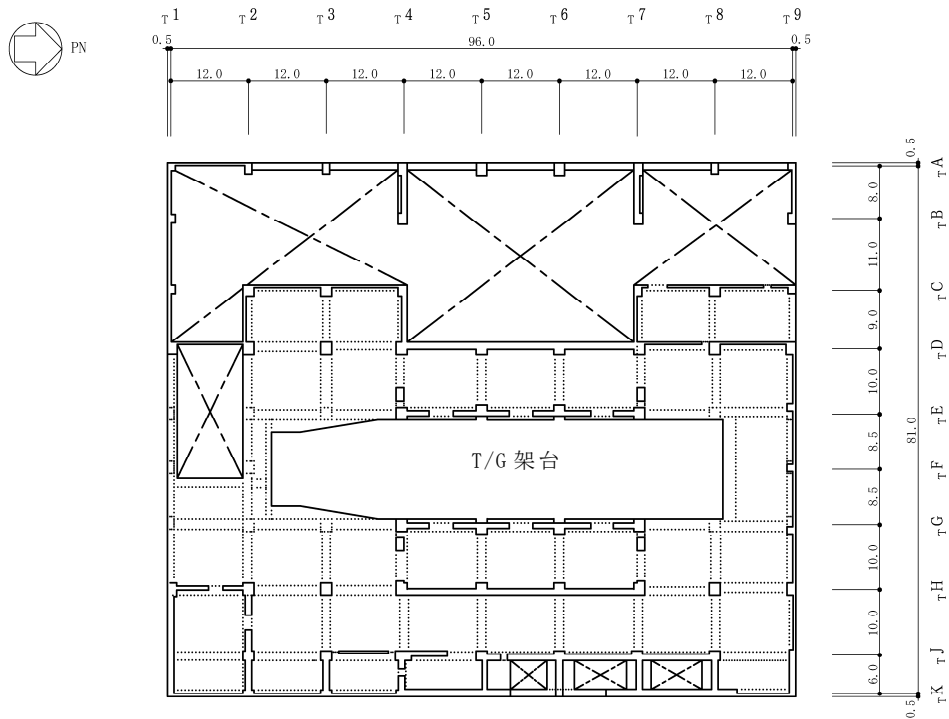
タービン建屋の概略平面図 (2F, T.M.S.L. 20.4m) (4/6) (単位 : m)
